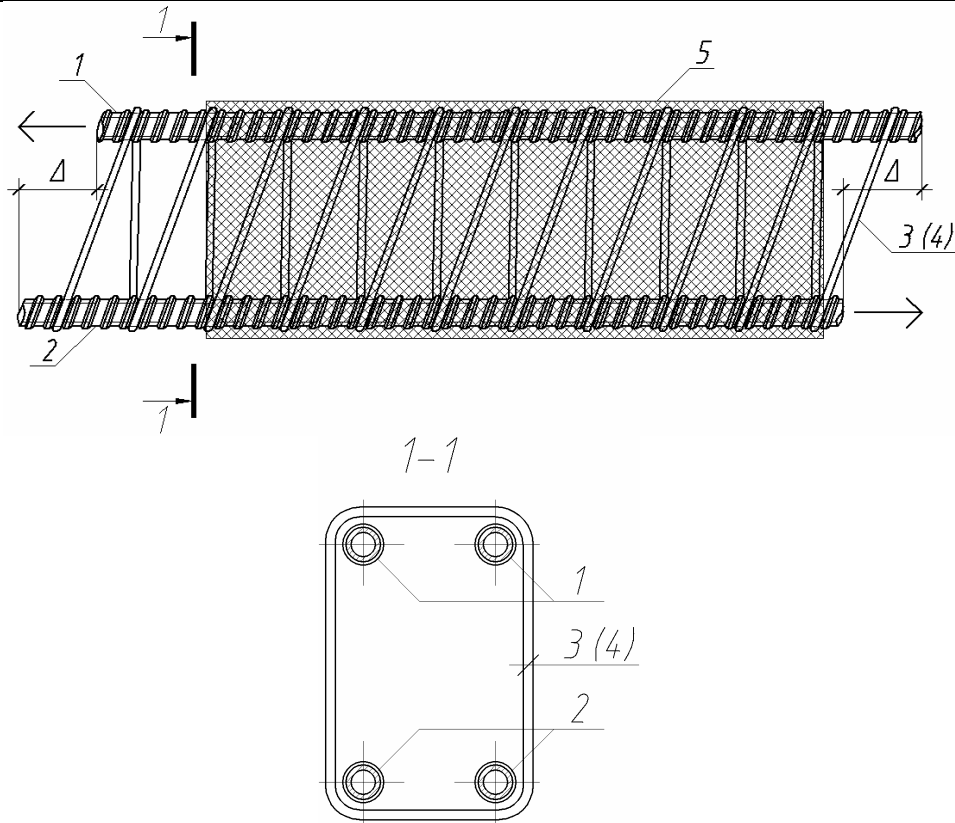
Фрагмент смонтированного внутри кольчуги арматурного каркаса:
